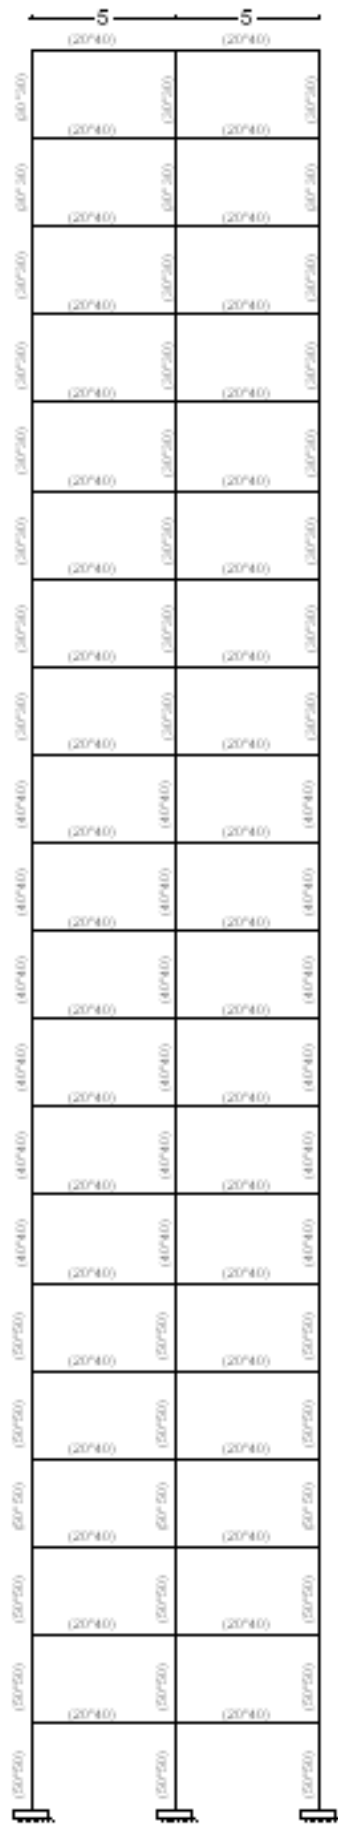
coffrage du portique de la coupe A-A (servis XX) bâtiment 03.
